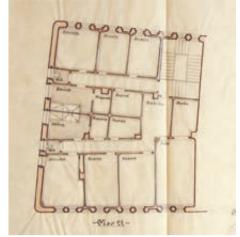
Planta segunda del proyecto de casa consistorial de Cosuenda, 1921 (A.D.P.Z.).
